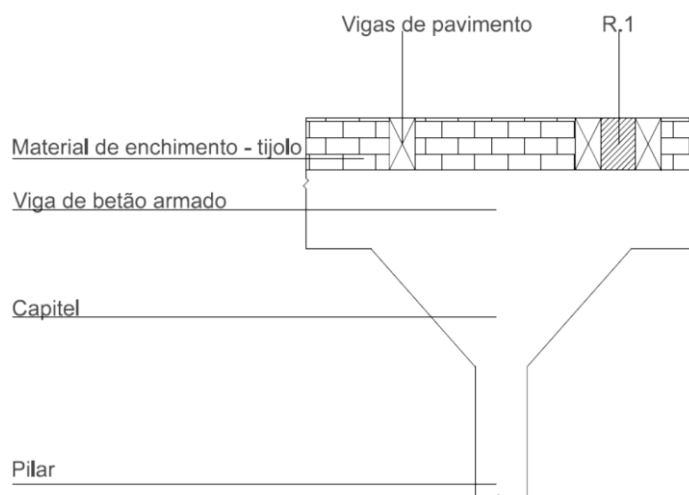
Corte representativo da ligação entre viga e pilar
